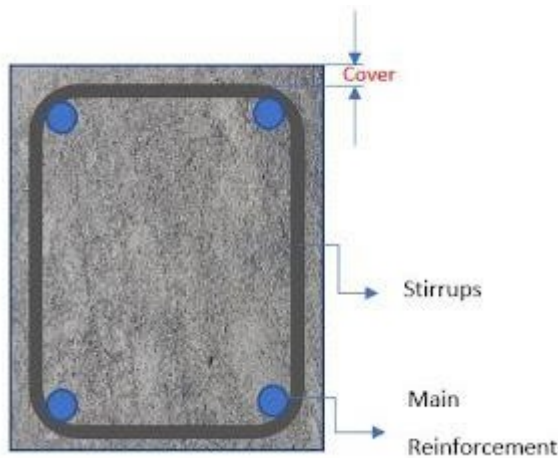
Secțiune transversală a unui stâlp armat (Anre, 2020)
